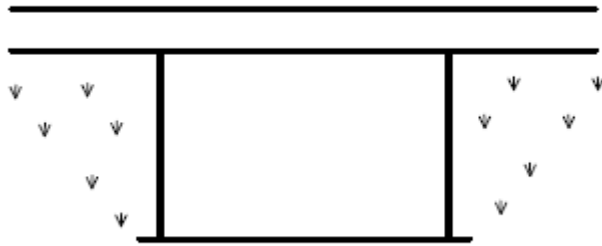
Vhodné konstrukce propustků [20]
